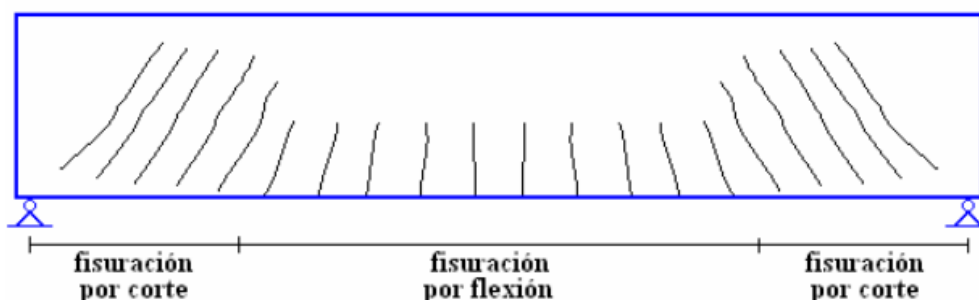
Grietas por flexión y cortante de una viga
